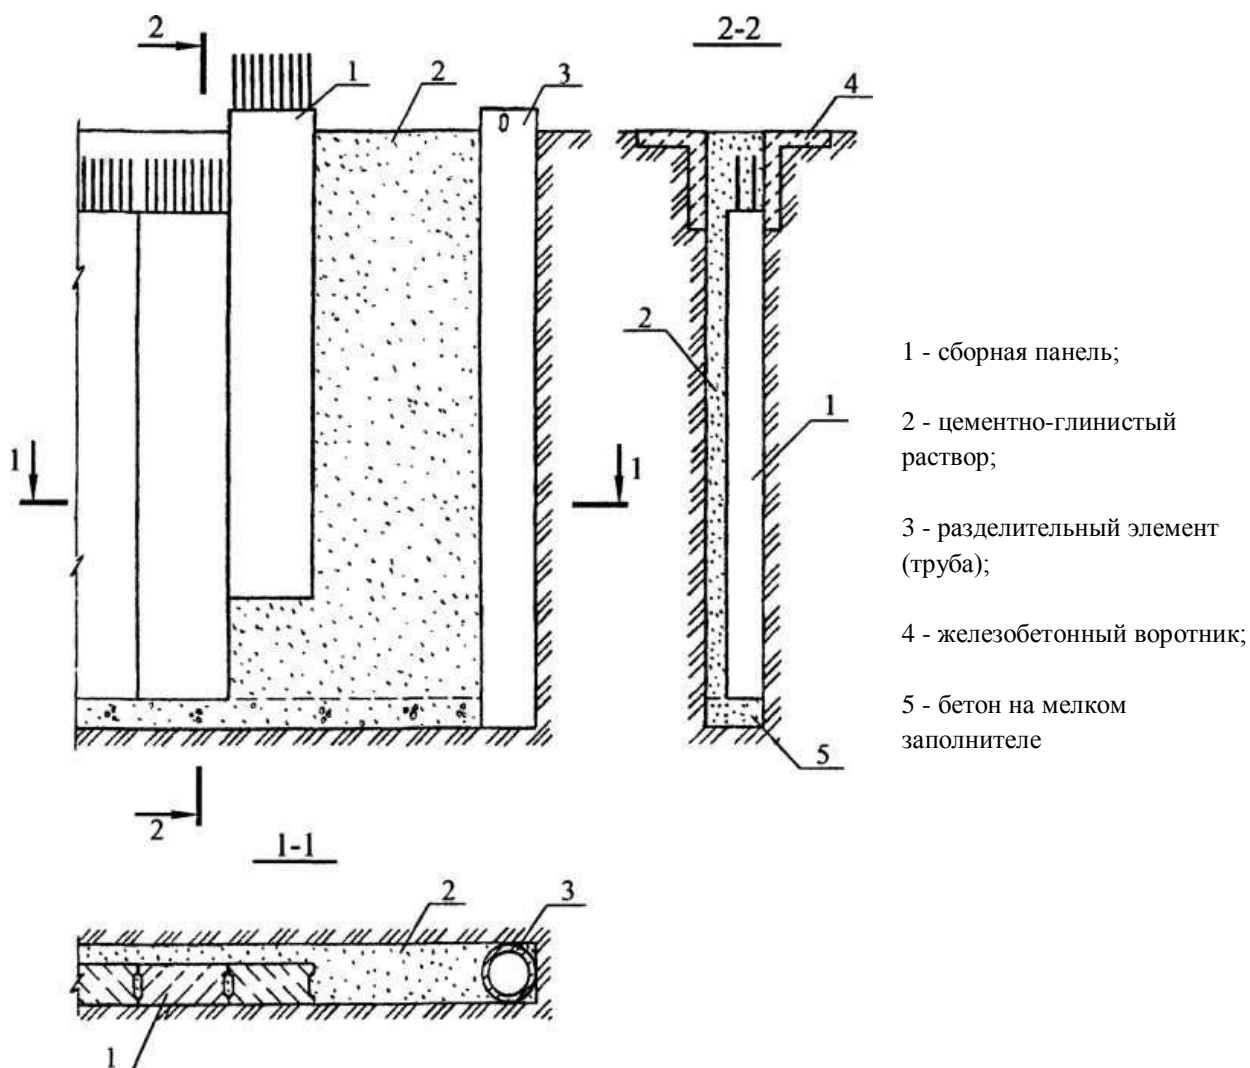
Схема производства работ при возведении стен способом «стена в грунте» из сборного железобетона
